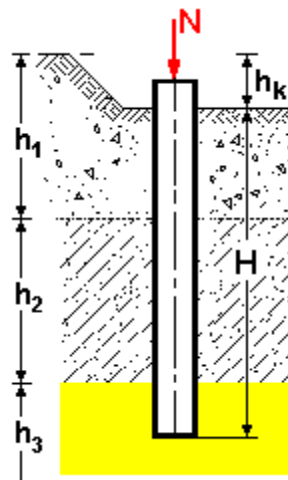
Расчетная схема сваи для расчета на осадку
